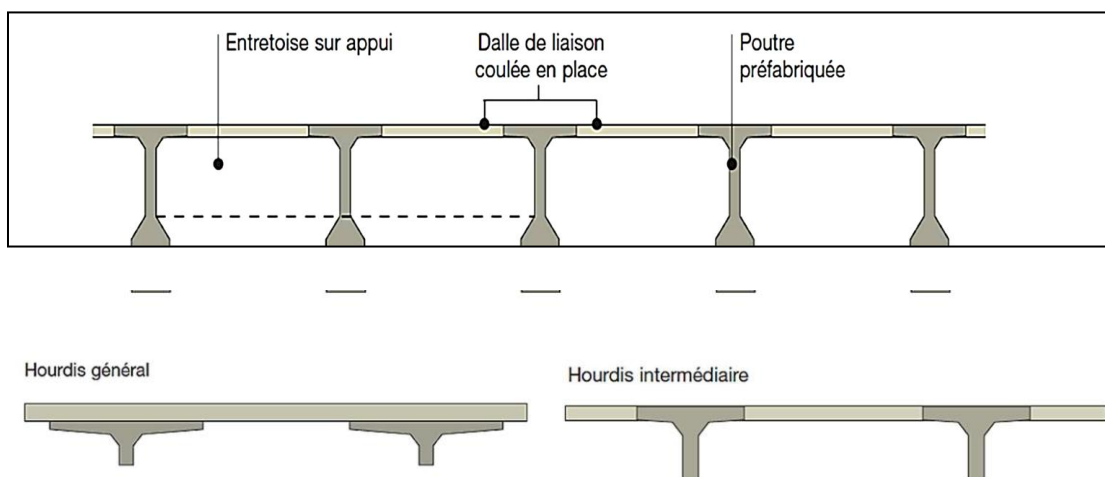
Coupe transversale d'un pont à poutre précontrainte
